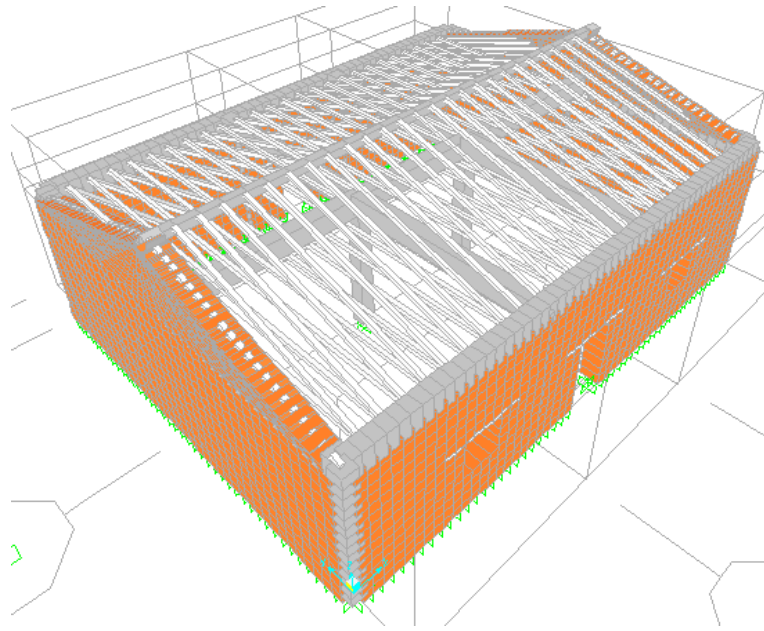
Modelo da estrutura 5.1 com a introdução de estrutura em betão armado
